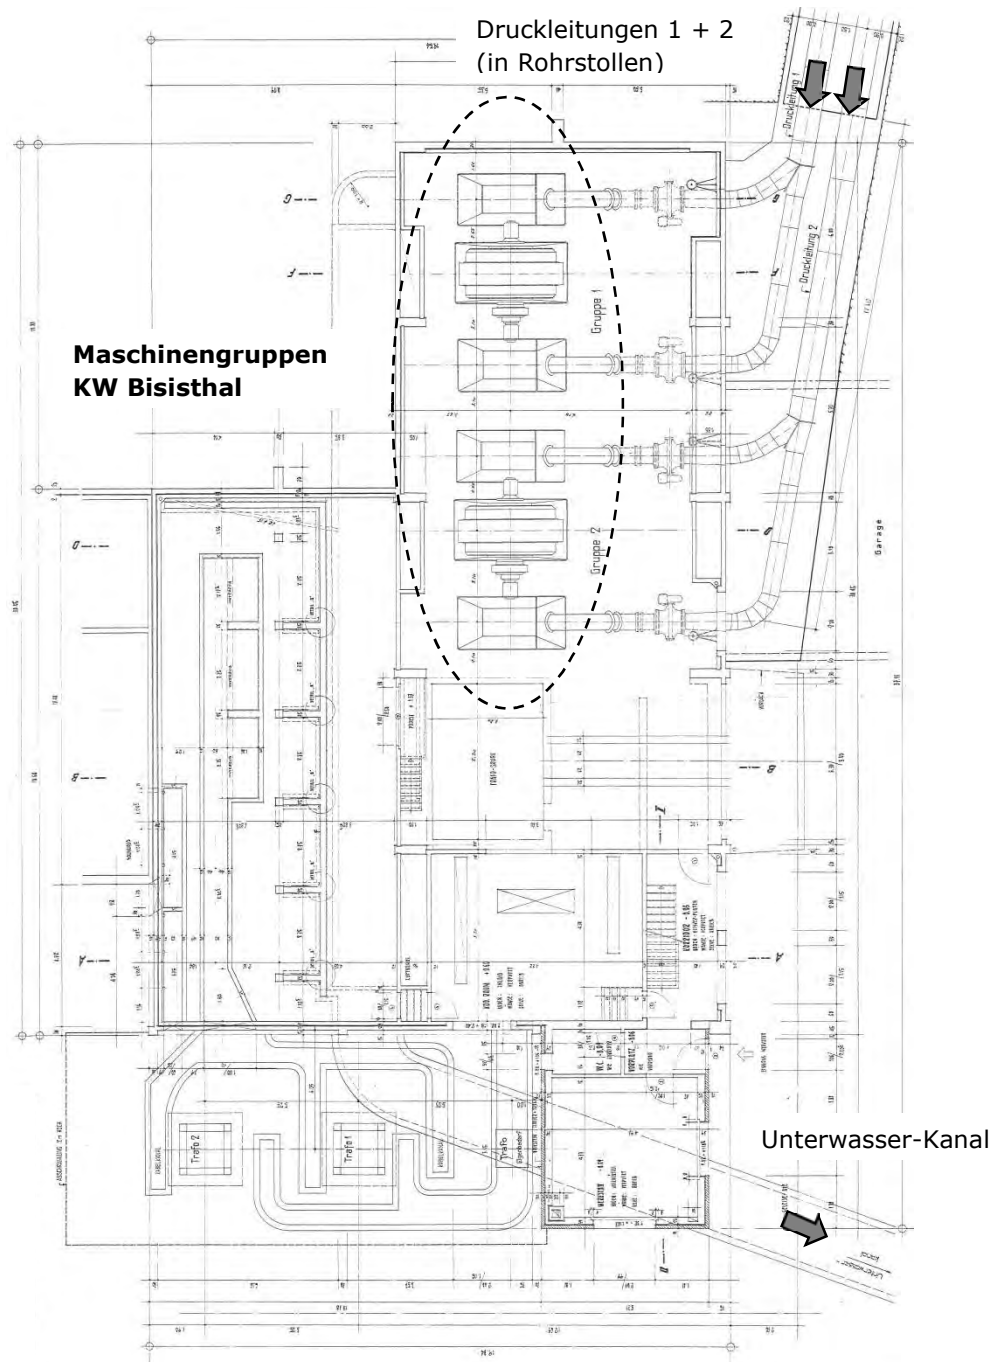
Grundriss des bestehenden Maschinenhaus Bisisthal (Erdgeschoss, Ausschnitt Plan Nr. 500-103).
